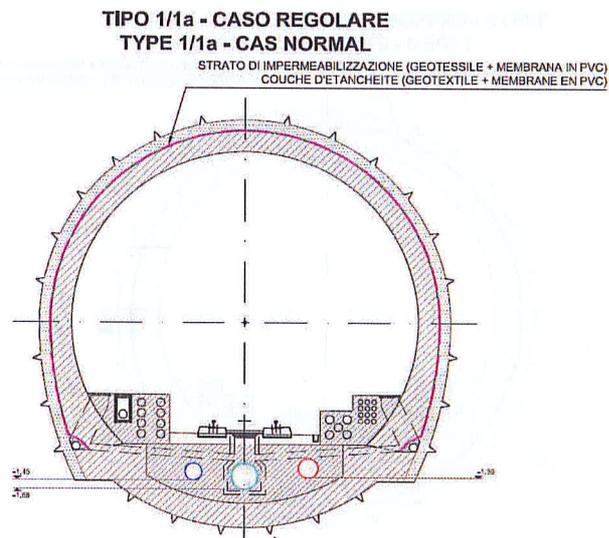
Impermeabilizzazione di tipo 1/1a per scavo tradizionale
